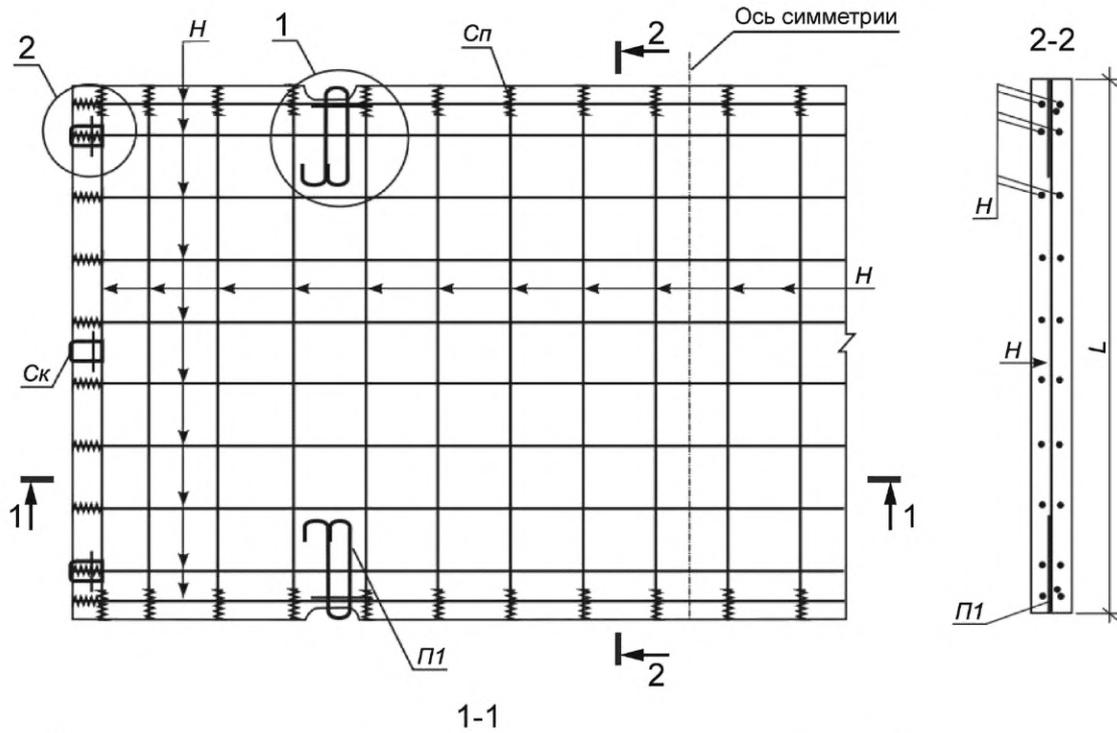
Схемы армирования плит П60.38, П60.35, П60.30
